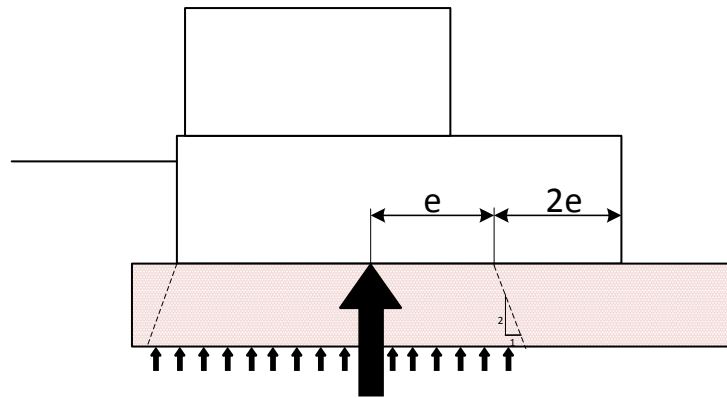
Расчетная схема к определению давления на грунтовое основание
